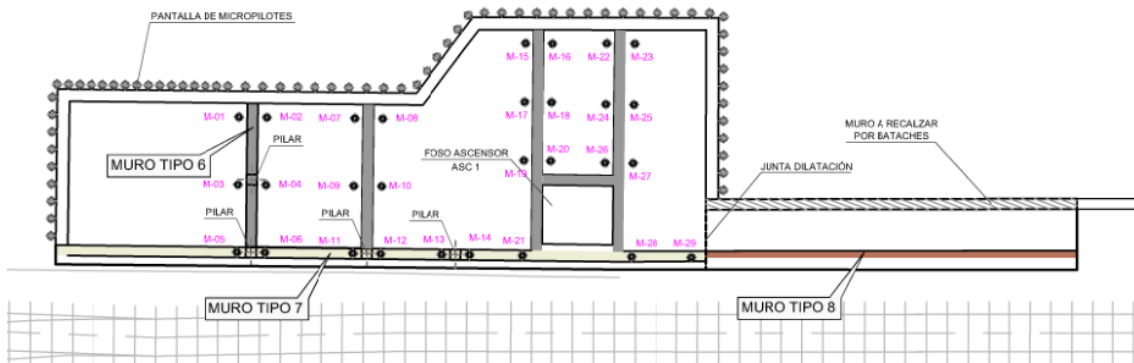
Planta de cimentación y arranques de muros y pilares de estación Donostia
